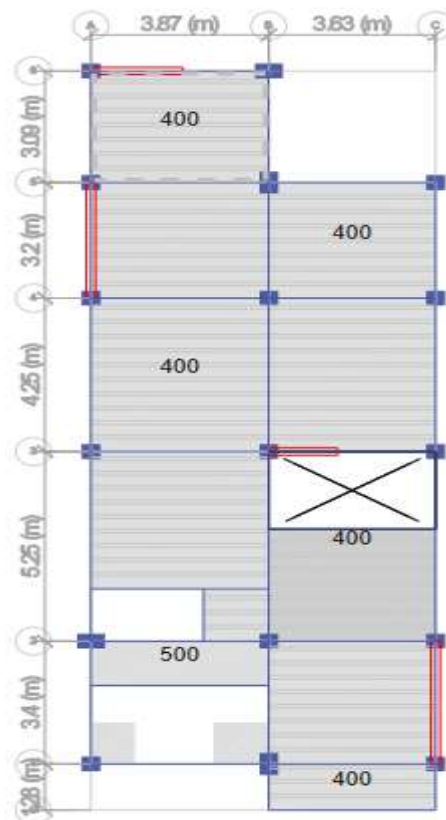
Vista de Planta Asignación de Carga Viva live 02 del 4to piso
